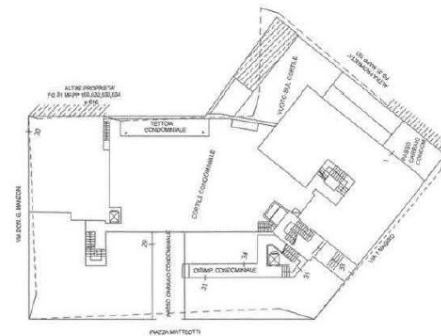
Estratto dal catasto - stralzo dell'elaborato planimetrico relativo al piano terra dello stabile
